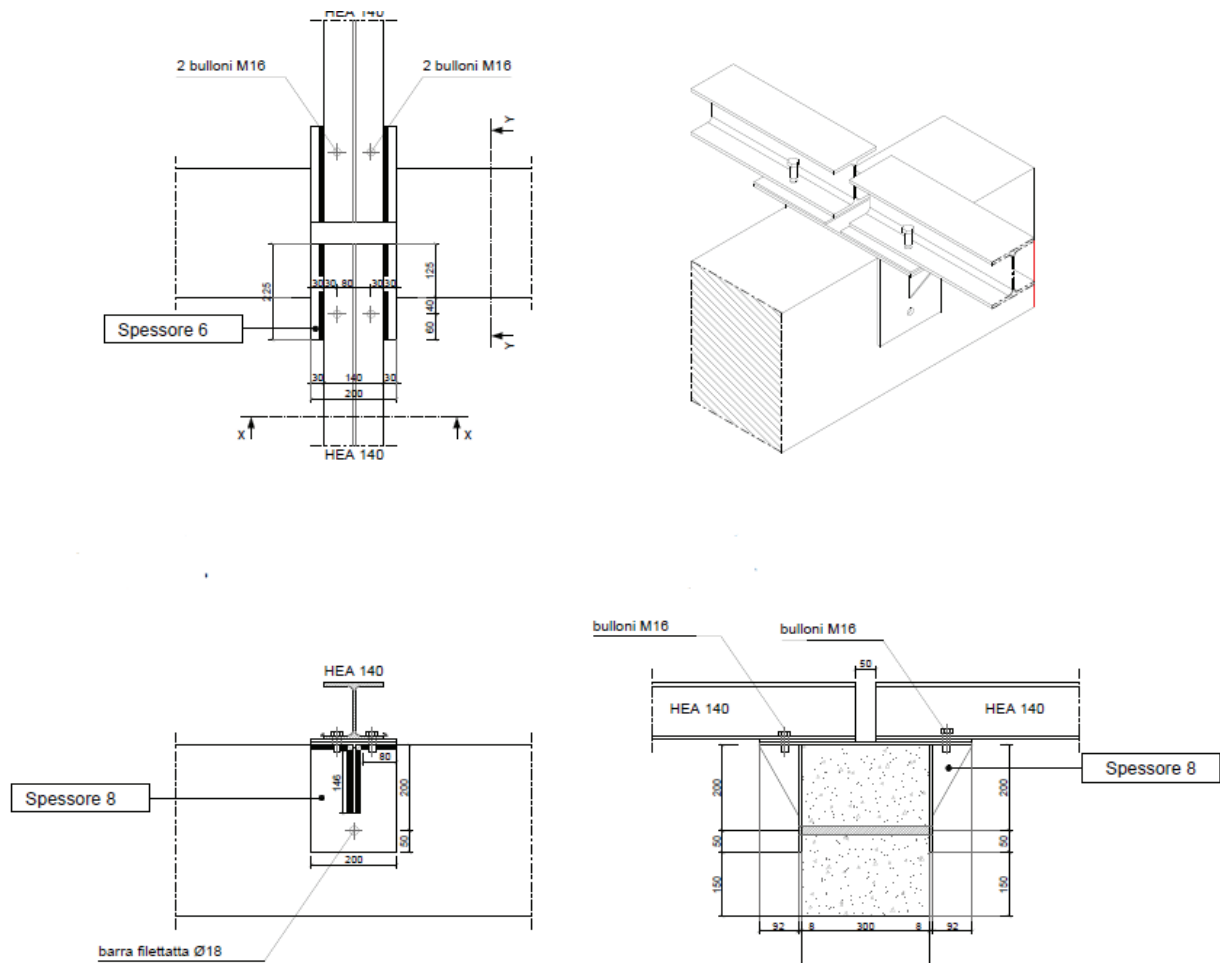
dettaglio ancoraggio struttura in acciaio alle travi esistenti
